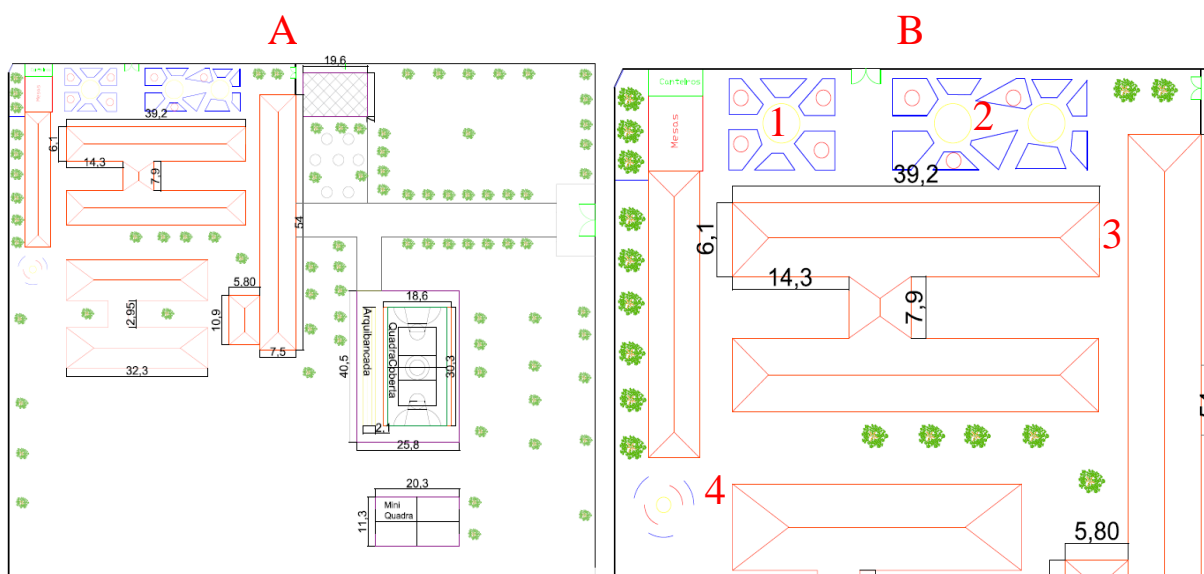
Lado A: Planta baixa geral realizada de forma parcial. Lado B: Visão expandida das áreas reestruturadas na escola. Salinas/MG.
